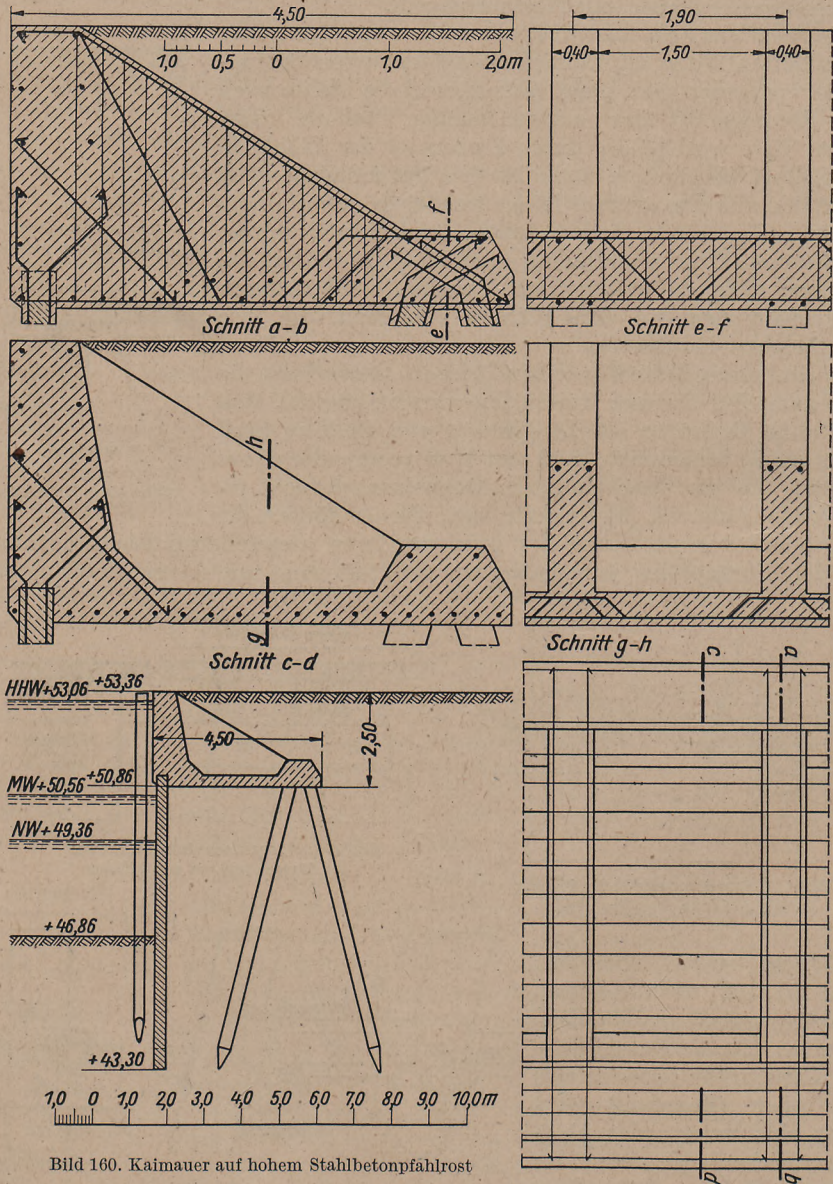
Kaimauer auf hohem Stahlbetonpfahlrost
